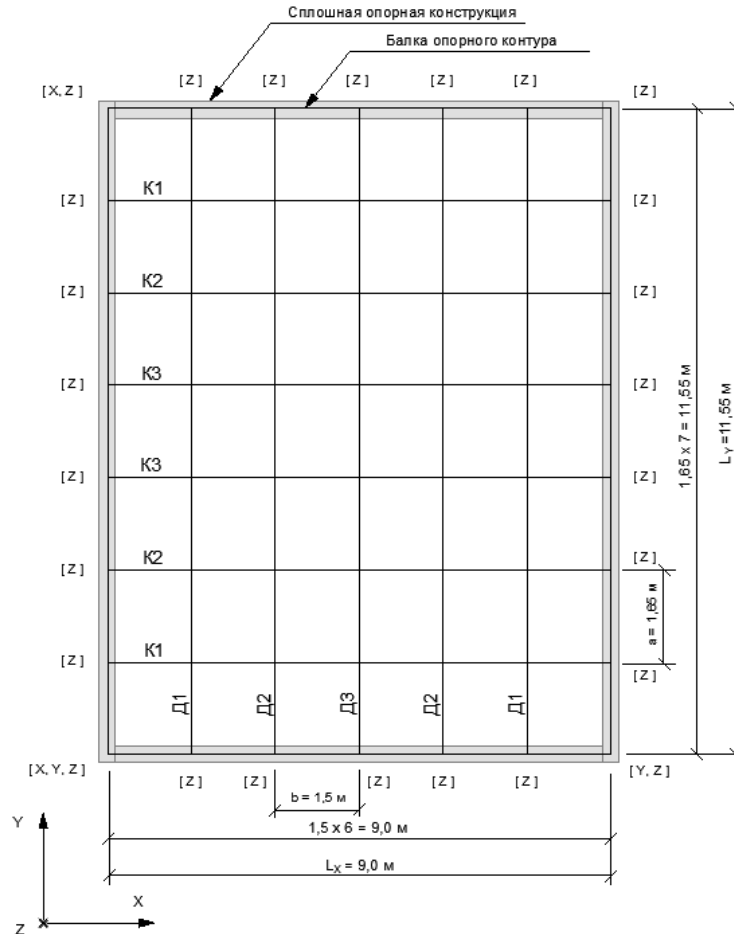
Схема кессонного перекрытия размером в плане 9,0×11,55 м с кессонами 1,5×1,65 м. К1, К2, К3, Д1, Д2, Д3 – рассчитываемые балки. [X, Y, Z] – связи, установленные в узлах балки опорного контура
